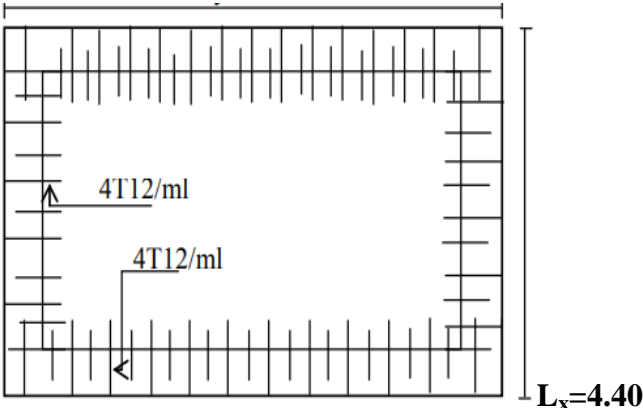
Dessin Ferrailage Supérieur du panneau de la dalle pleine.
